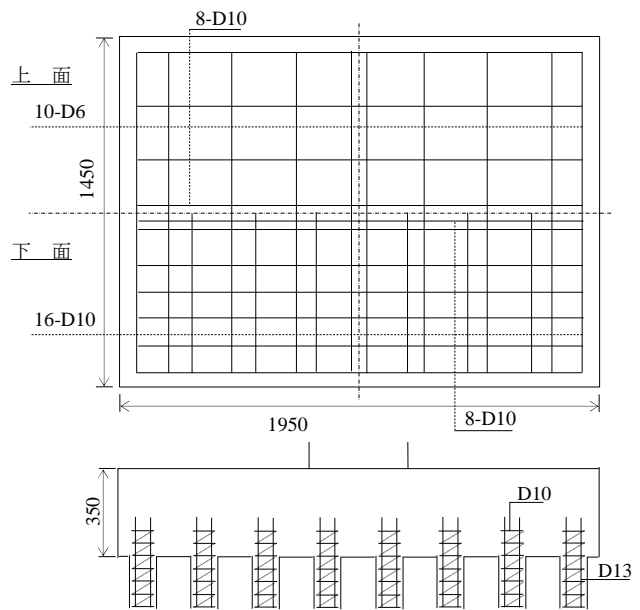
実験試験体配筋図(フーチング・杭 単位: mm)
